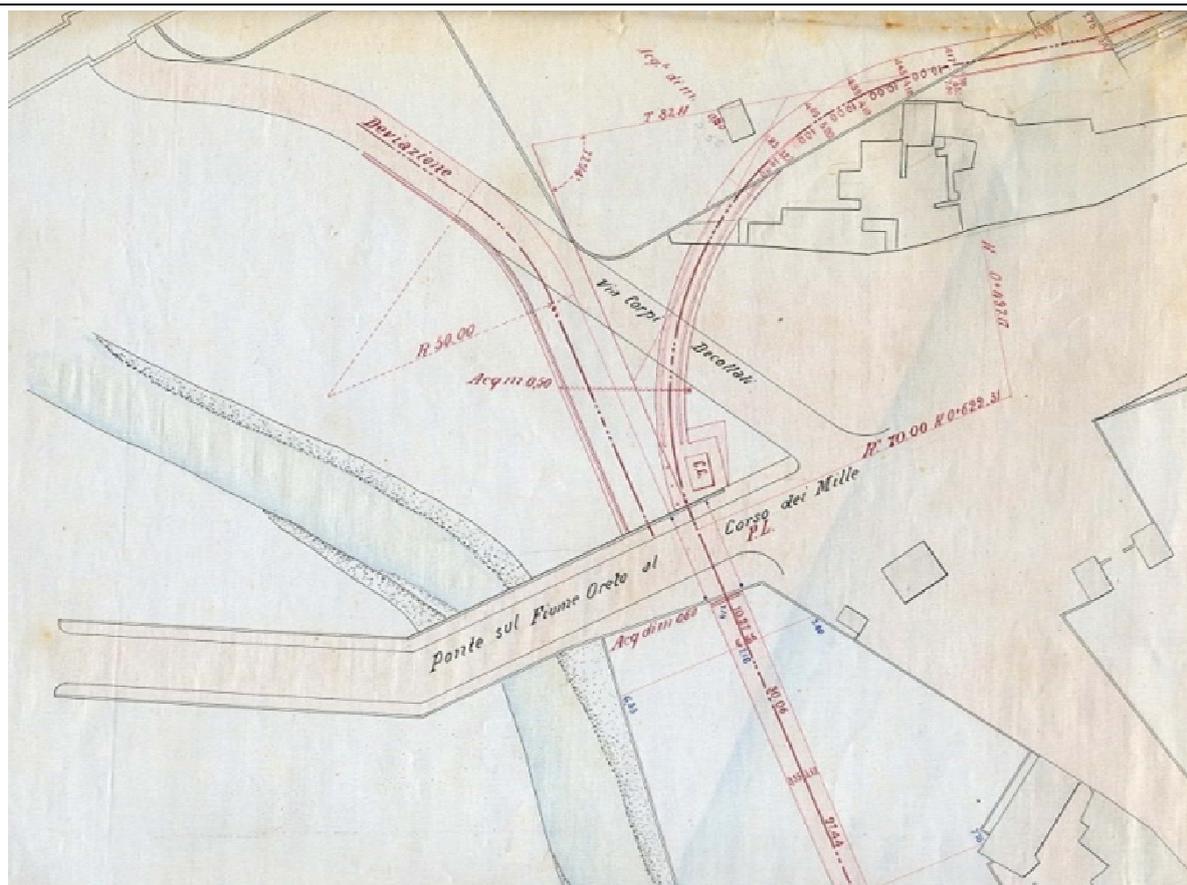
b) Stralcio del progetto precedente (ruotato) limitato all'area del ponte delle Teste col tracciato ferroviario previsto in progetto.
